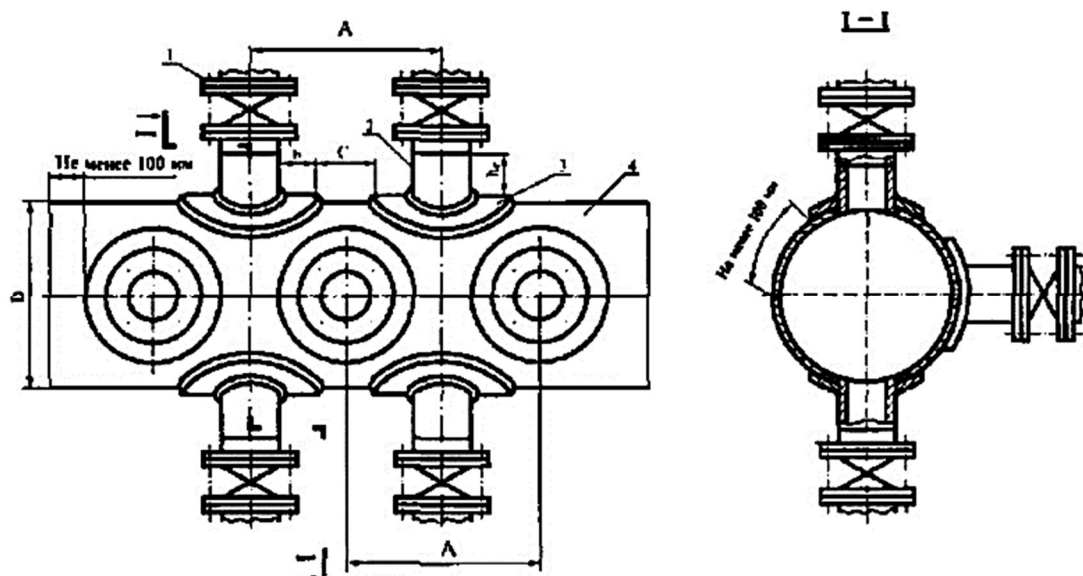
Схема расстановки вантузов при врезке для откачки нефти: 1 – задвижка; 2 – патрубок; 3 – усиливающая накладка (воротник); 4 – ремонтируемый трубопровод; А – расстояние между вантузами; b – ширина усиливающего воротника; D – диаметр трубопровода; h_n – высота патрубка (определяется техническими параметрами применяемого для вырезки приспособления) – не менее 100 мм; c – минимальное расстояние между усиливающими воротниками
